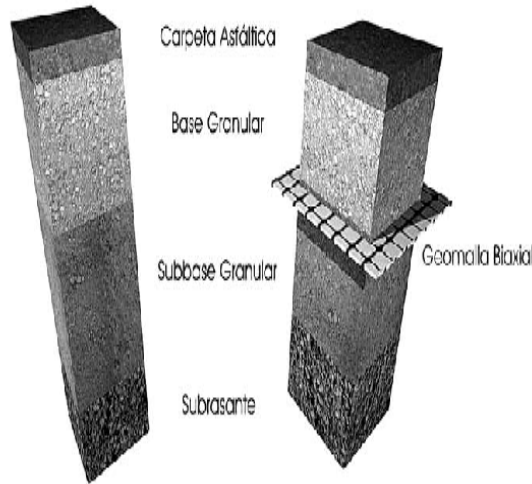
Sección típica de estructuras de pavimento asfáltico
